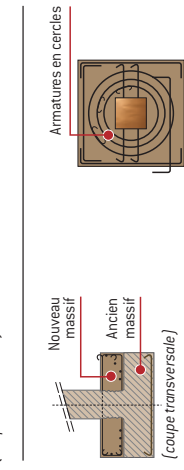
Fondations : sans augmentation de la surface de semelle (vue en plan)
